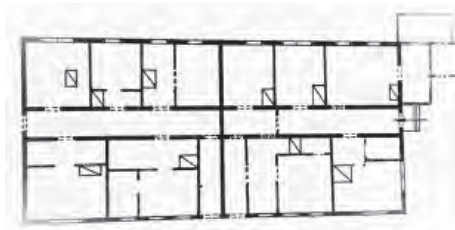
План деревянного флигеля по ул. Урицкого. Дворовый фасад (КОПИК ПО)
